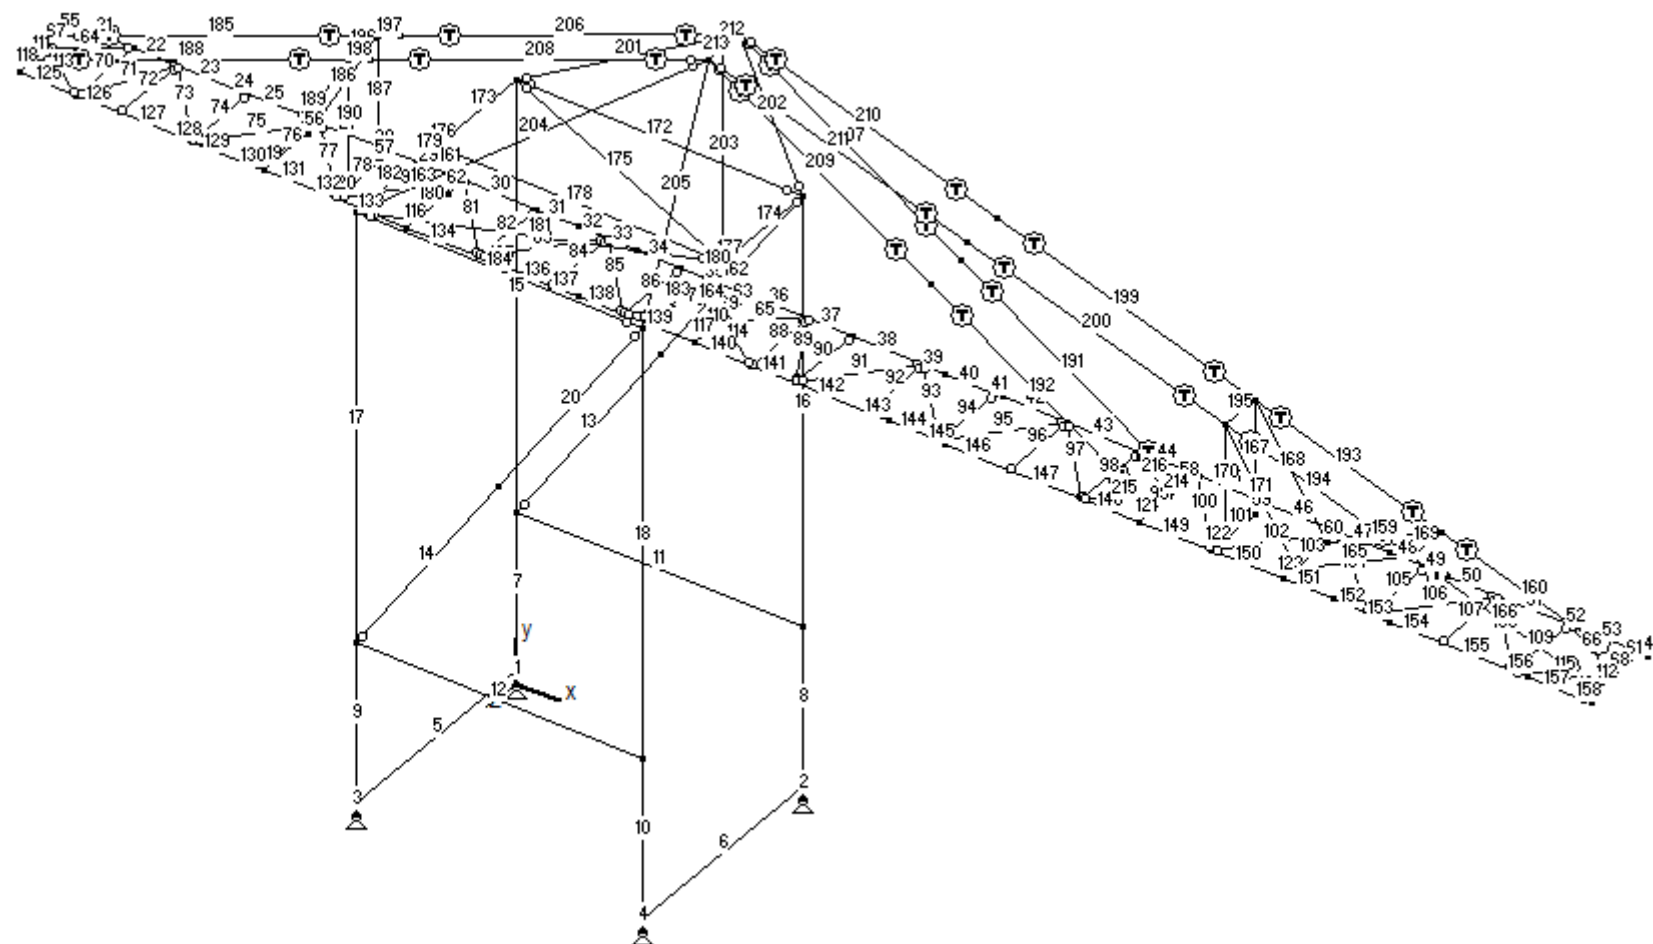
Identificação dos elementos estruturais do pórtico de cais (vista tridimensional)
